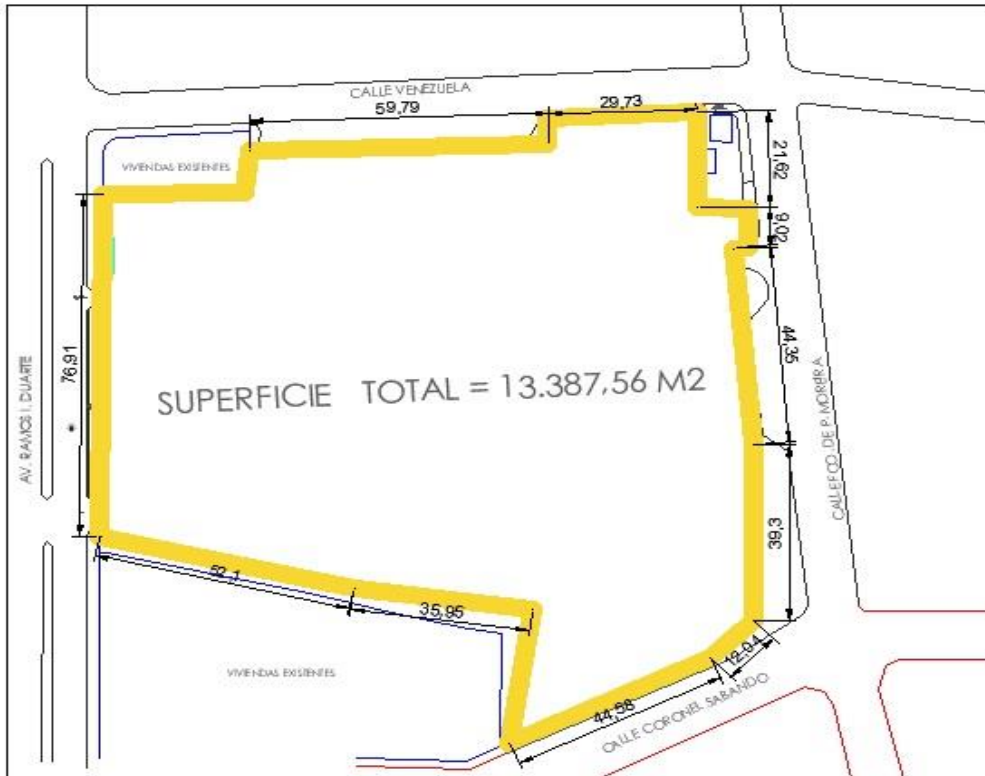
, Levantamiento planimétrico del entorno del Mercado N° 2 de Portoviejo
